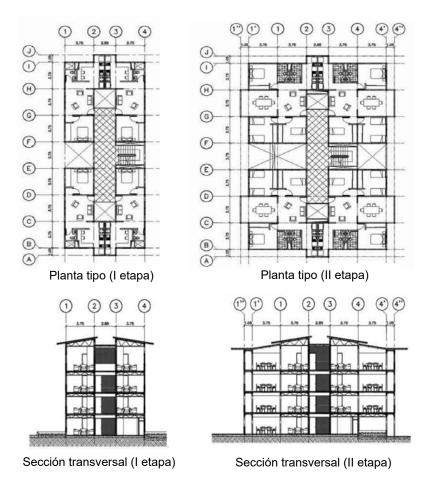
Plantas y secciones de la vivienda propuesta (Sistema SIEMA-VIV). (Hernández R., 2008)
